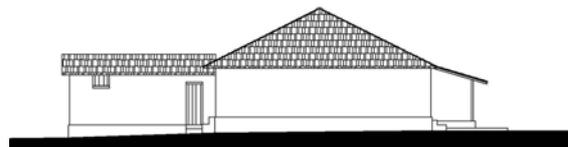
Fachada Noroeste (Acervo PROAU/FAU/UnB).
